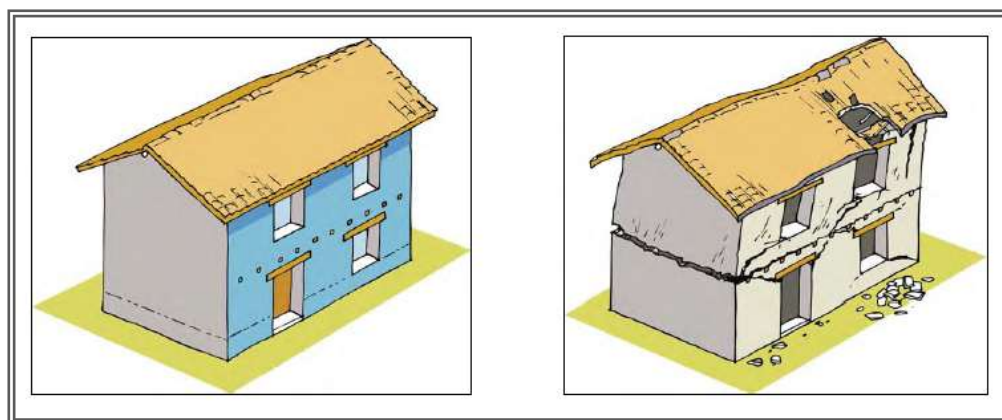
y 78. Tipo de Falla N. 7. Fuente: Manual de Rehabilitación para viviendas construidas en Adobe y Tapia Pisada. Página 4-7
